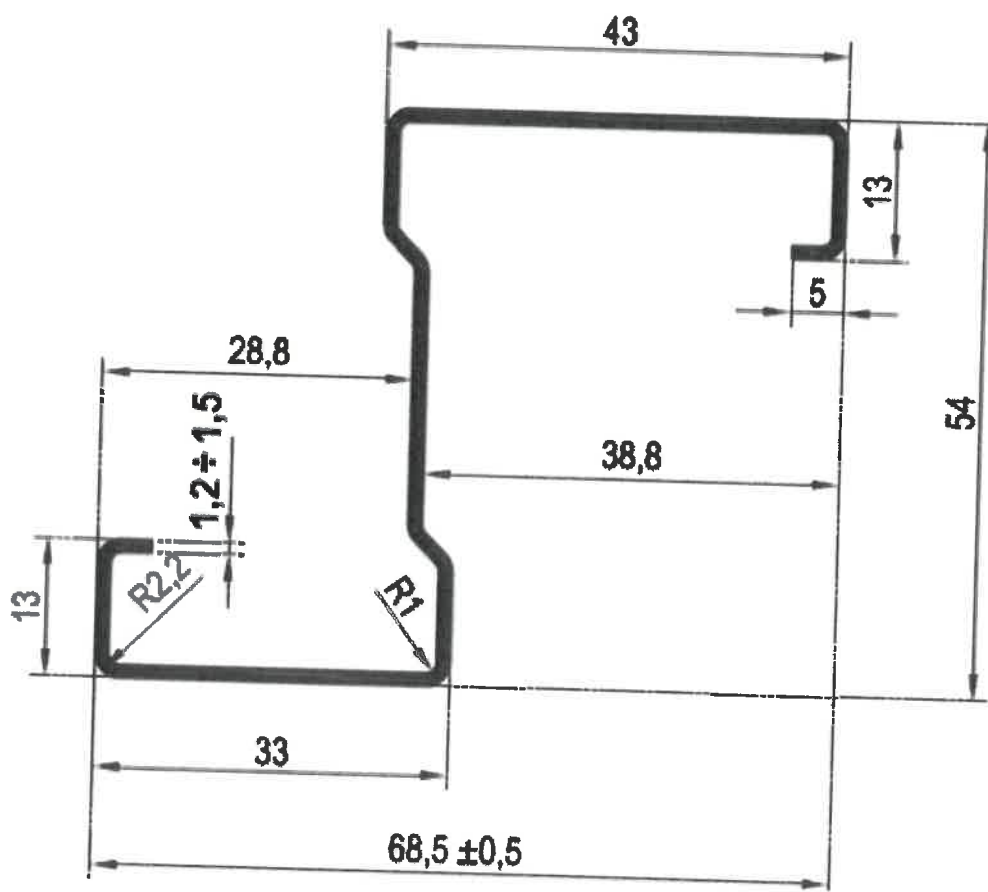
Ościeżnica stalowa DIN drzwi jednoskrzydłowych PAD EI30, PAD EI60 i PAD S60 – łączniki kątowe
